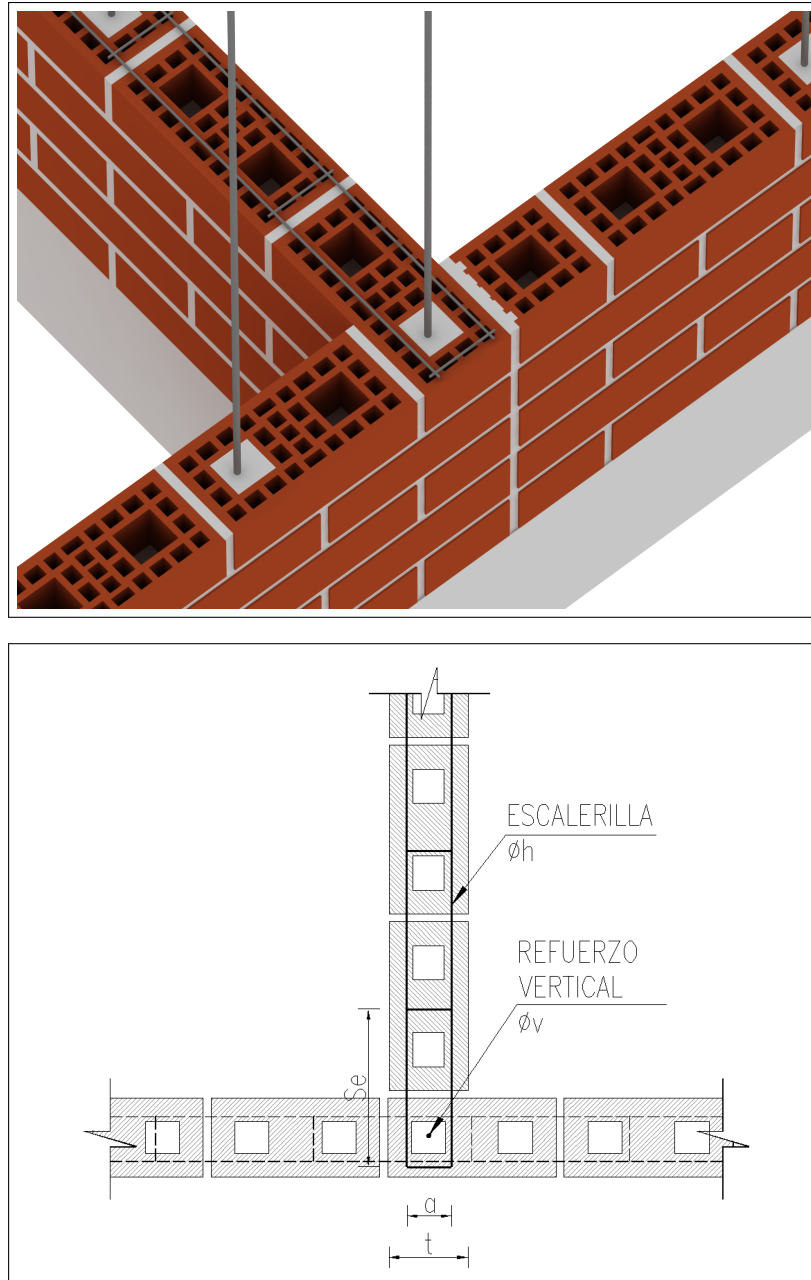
Detalle del anclaje del refuerzo horizontal (escalerilla) en un encuentro de muros en T . Alternativa B.
